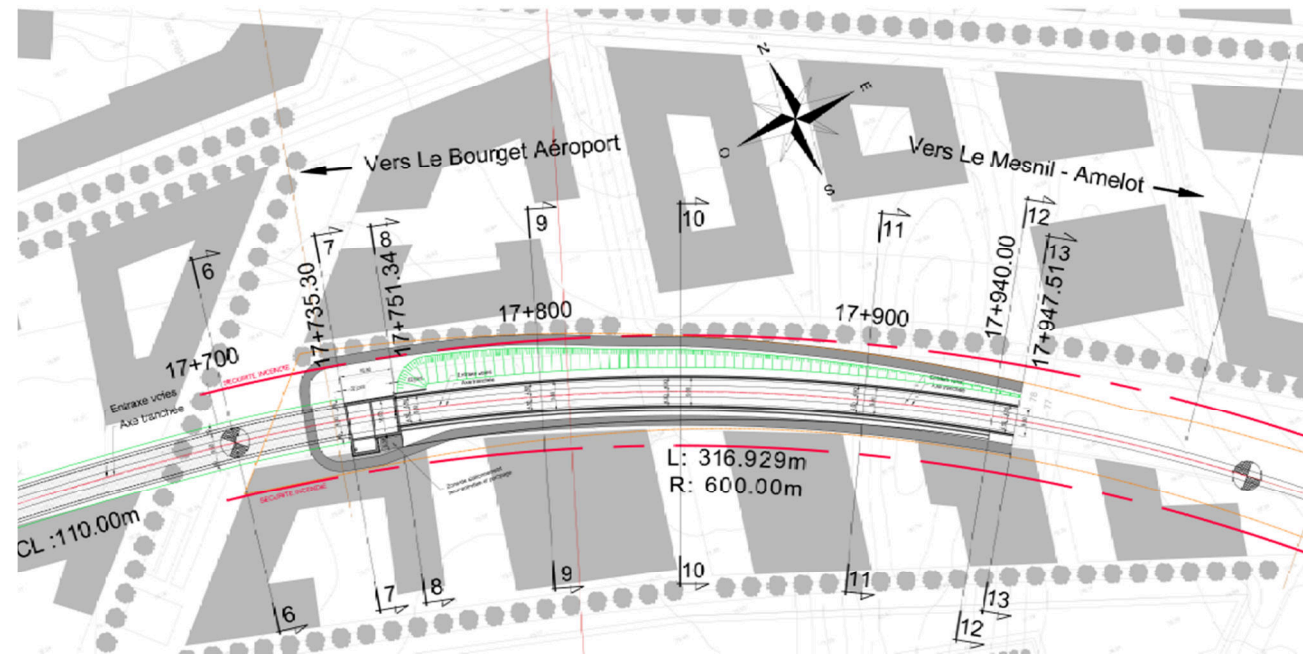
Plan masse du secteur en tranchée de la zone de transition Triangle de Gonesse
